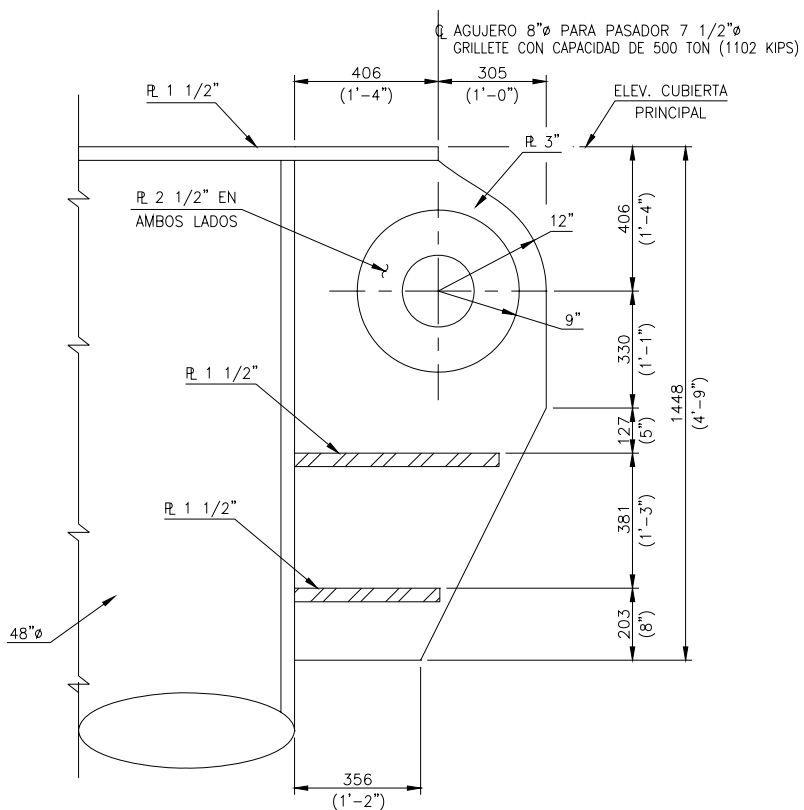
ARREGLO EN ELEVACION DE LA OREJA DE IZAJE TIPO
